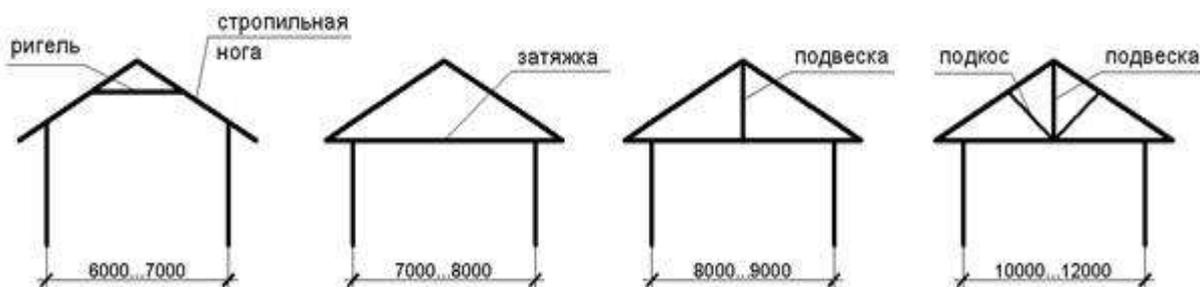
Скатная крыша. Варианты устройства стоек и подкосов, подвесок
